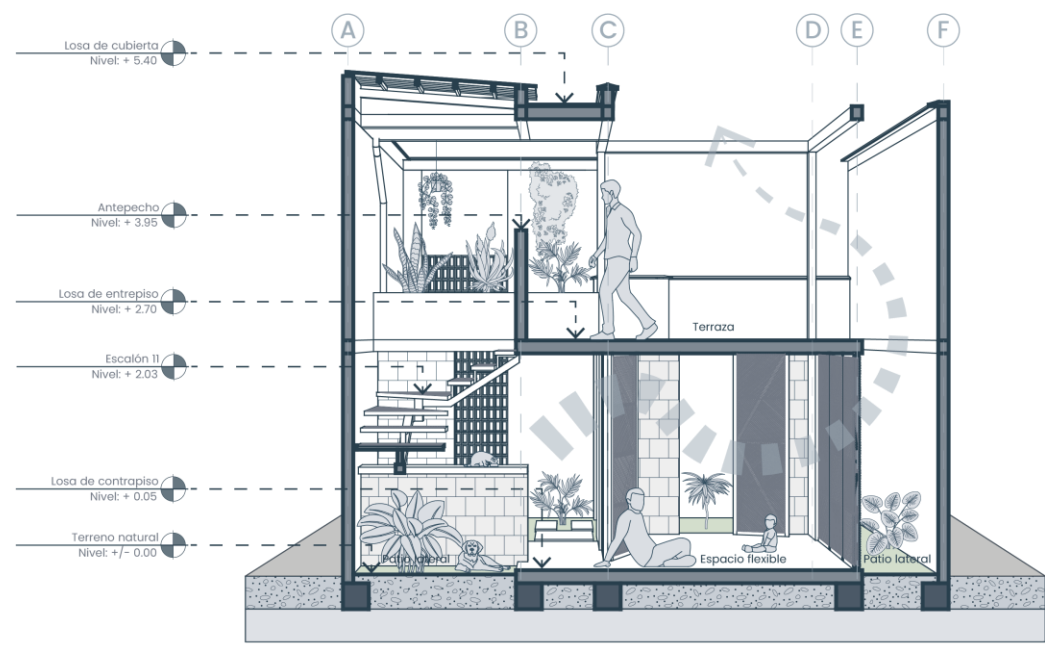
Corte longitudinal 1 Casa Patio. Elaboración propia.
